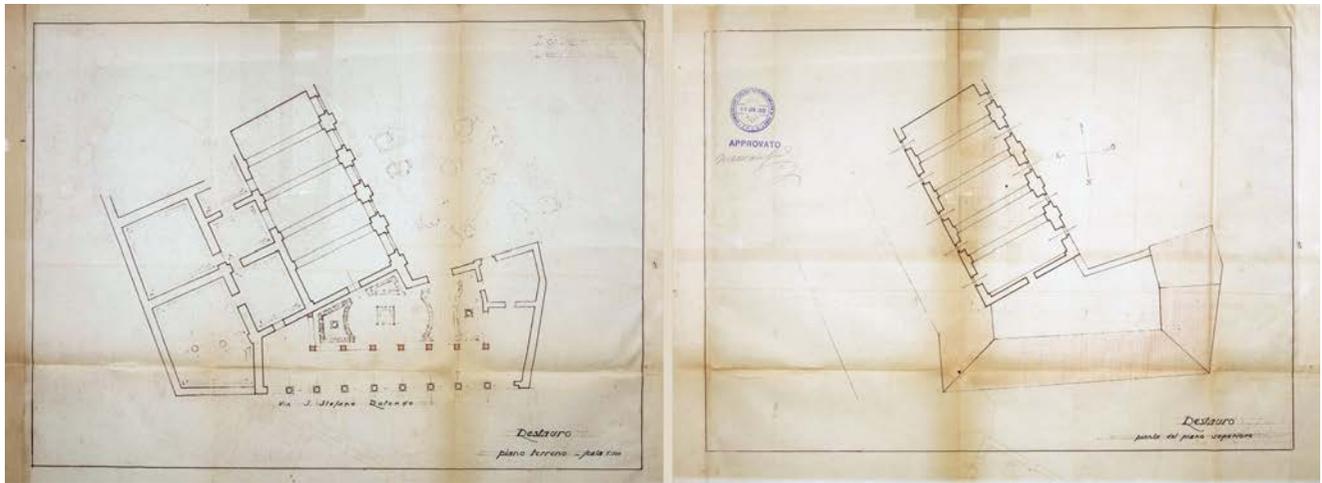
Progetto di restauro, prima proposta; pianta del piano terreno e del primo piano, 1927 (ASC, IE, Ospedale San Giovanni, prot. 9066; su concessione, divieto di riproduzione).
